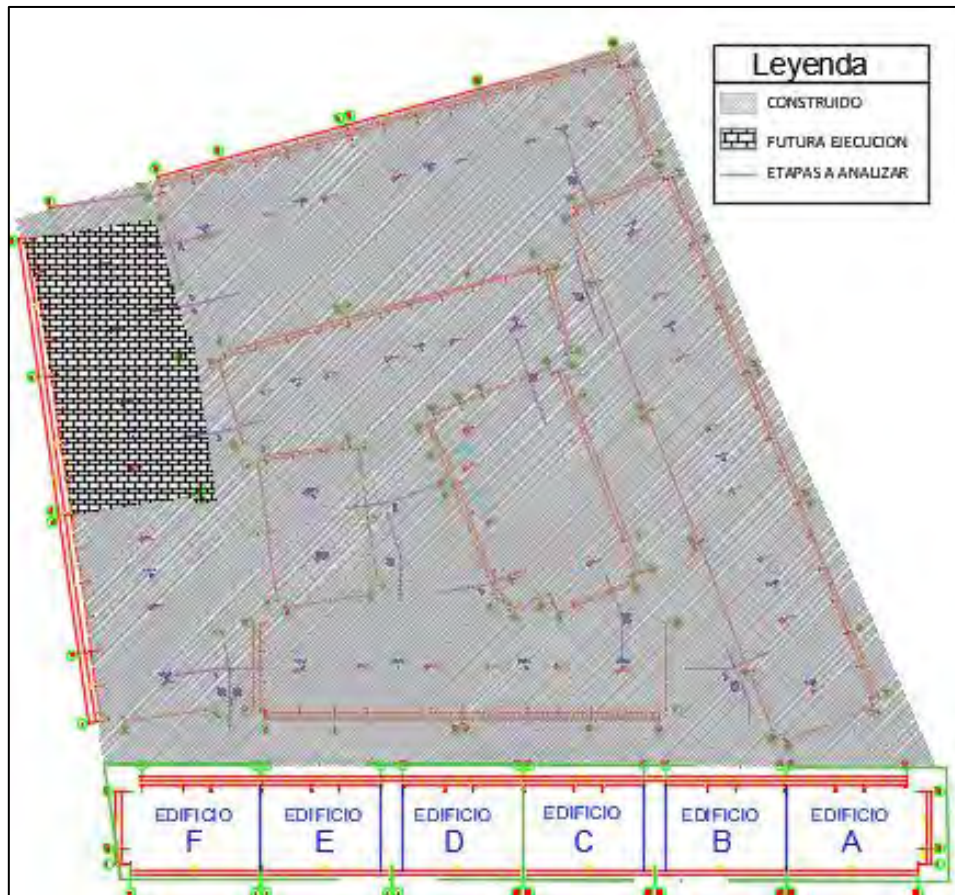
Plano de planta proyecto Ciudad Nueva
